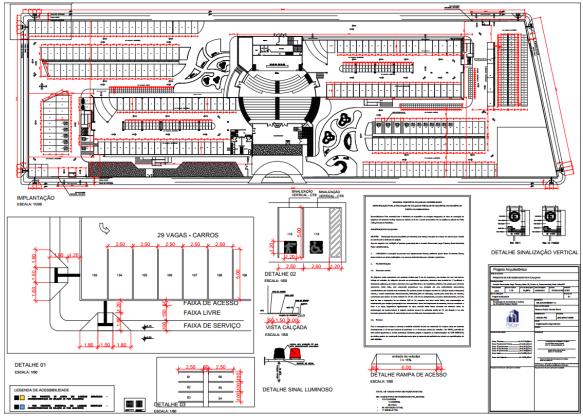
Projeto da área externa/estacionamento do novo campus.
